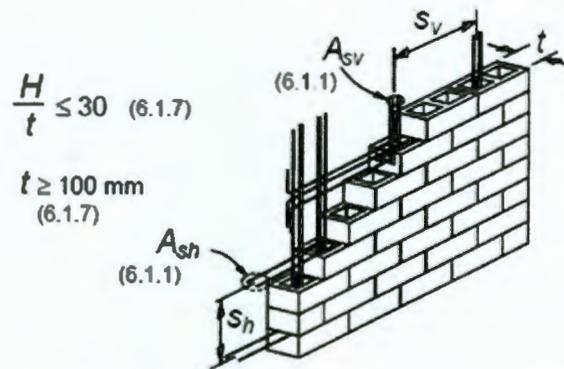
Requisitos para mampostería con esfuerzo interior (GDF, 2002)
